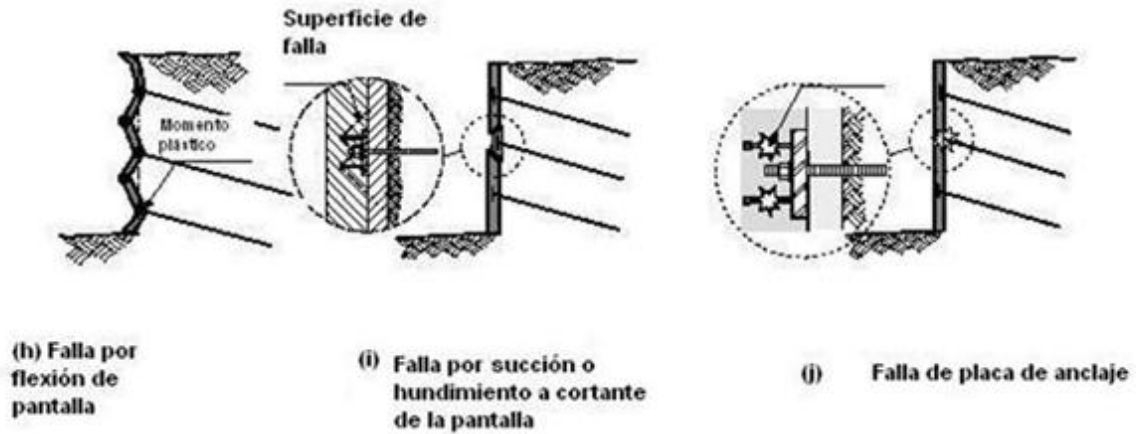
Modos de falla del muro de tierra armada o soil nailing.
